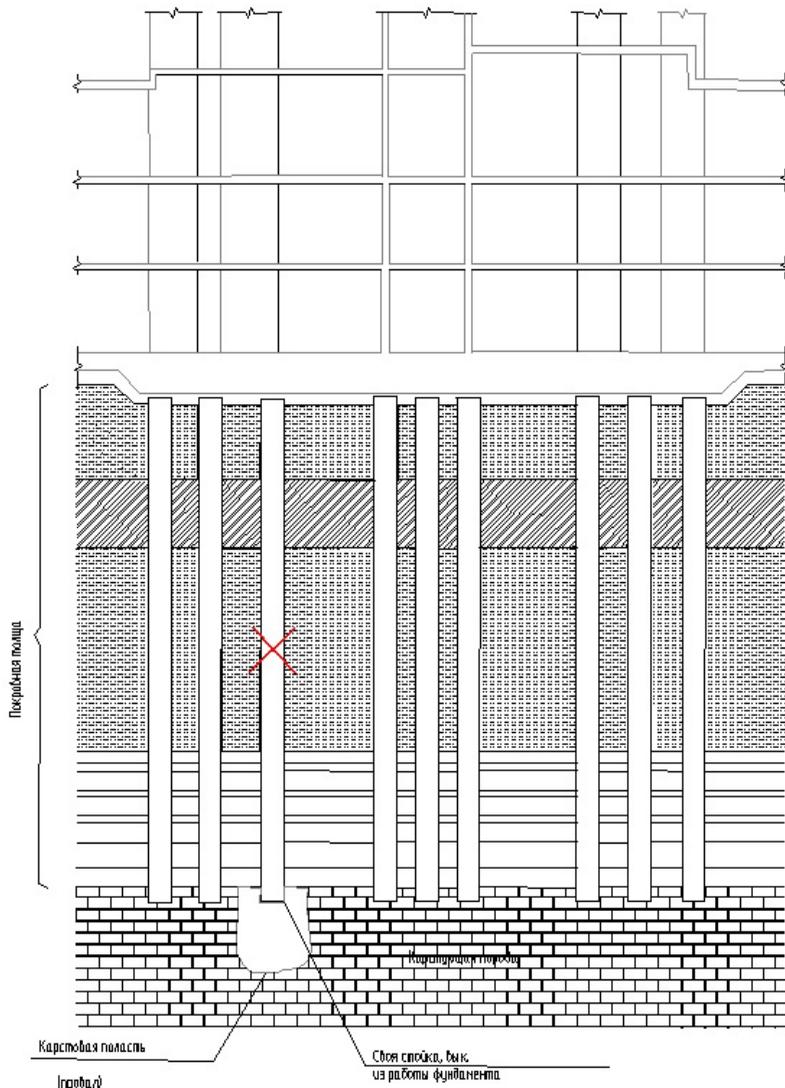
Расчетная схема фундамента на сваях-стойках (СП 499.1325800)
